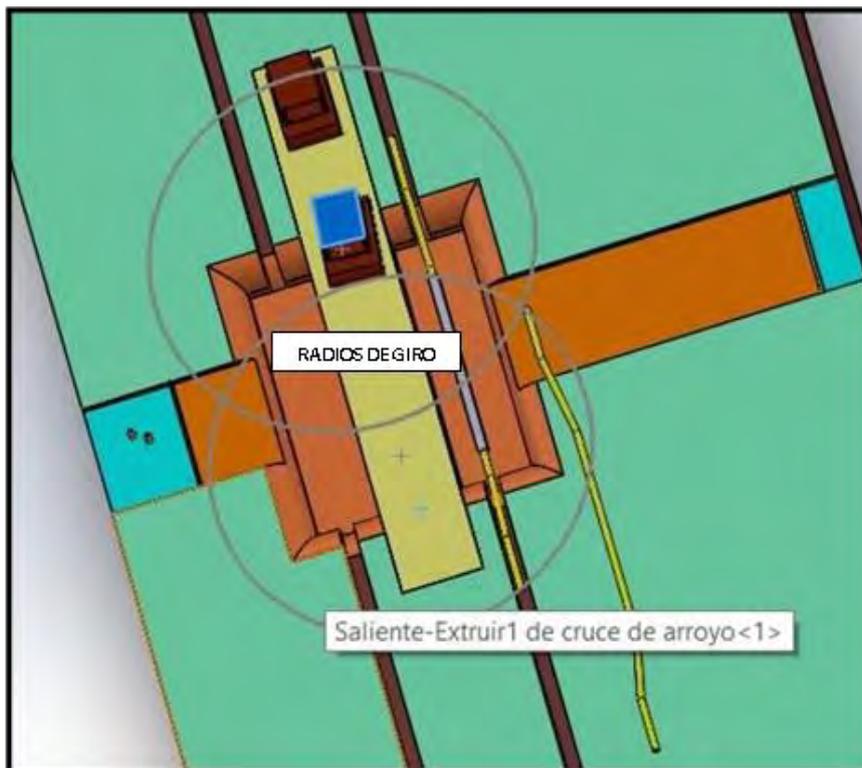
Detalle cruce arroyo Pareja (rectificado)
